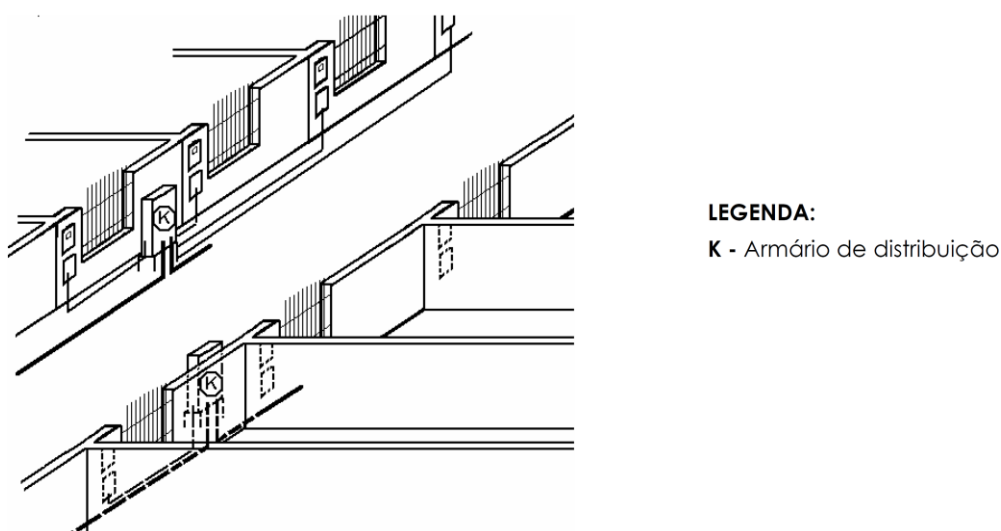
Ligações a partir de rede subterrânea, construções dotadas de muro [10]
